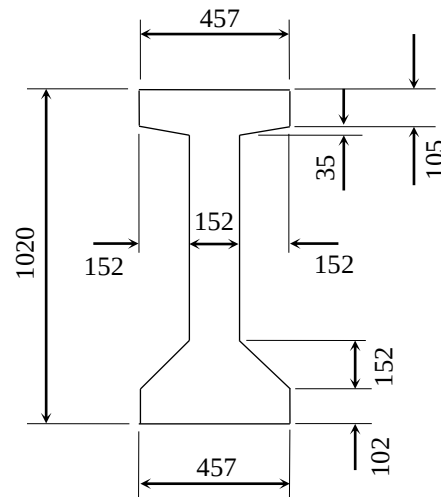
Dimensões (mm) da seção transversal da viga I.
